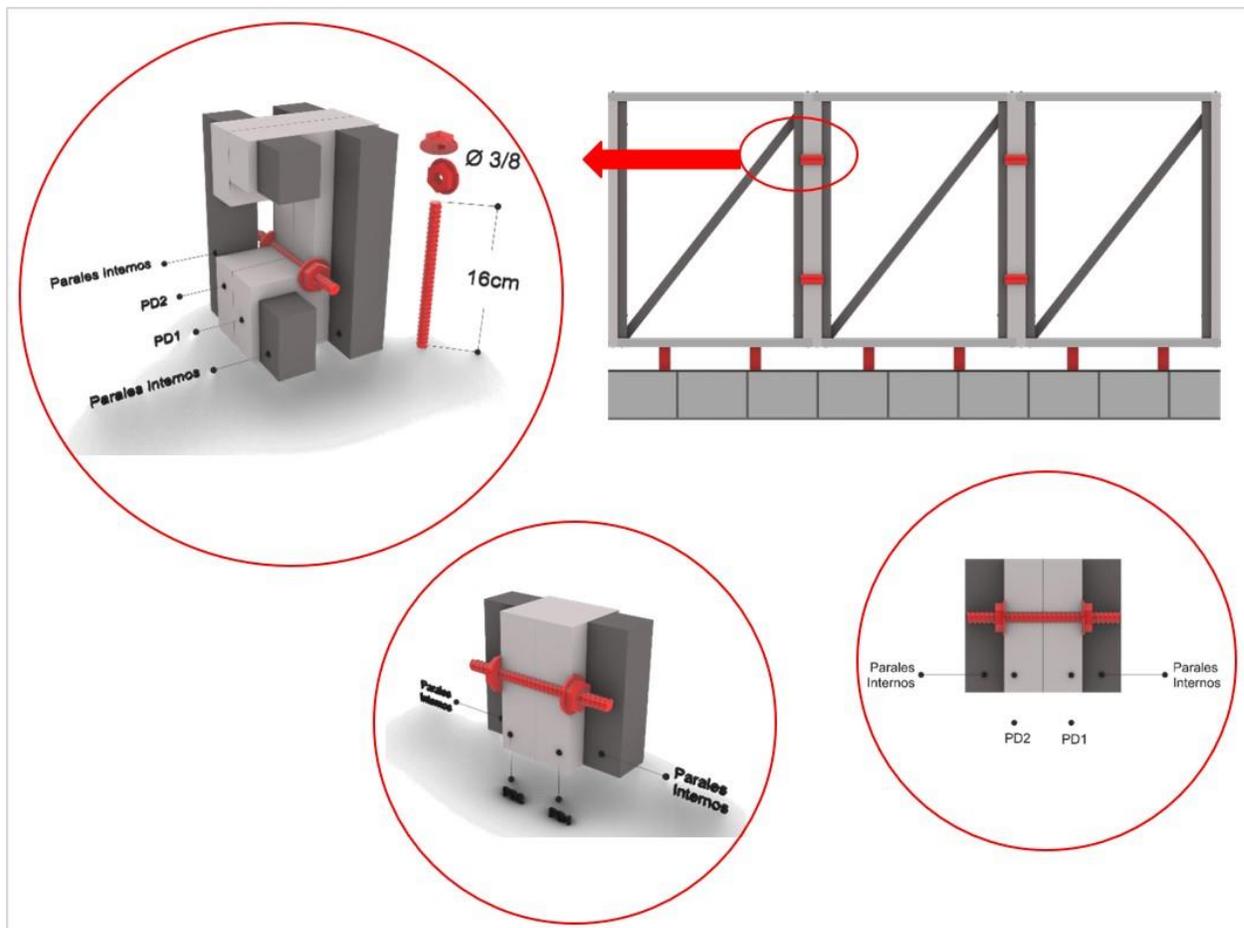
Detalle de Unión entre la hilada de bloques, el panel
